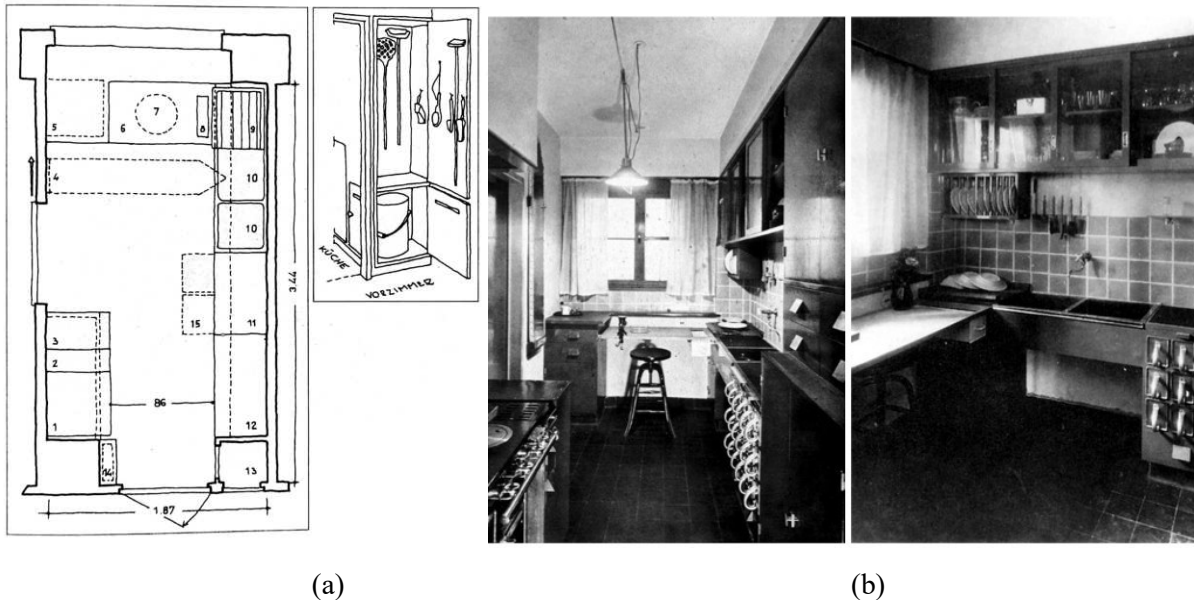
a) Pianta della cucina di Francoforte e armadio delle scope¹⁰⁵;
